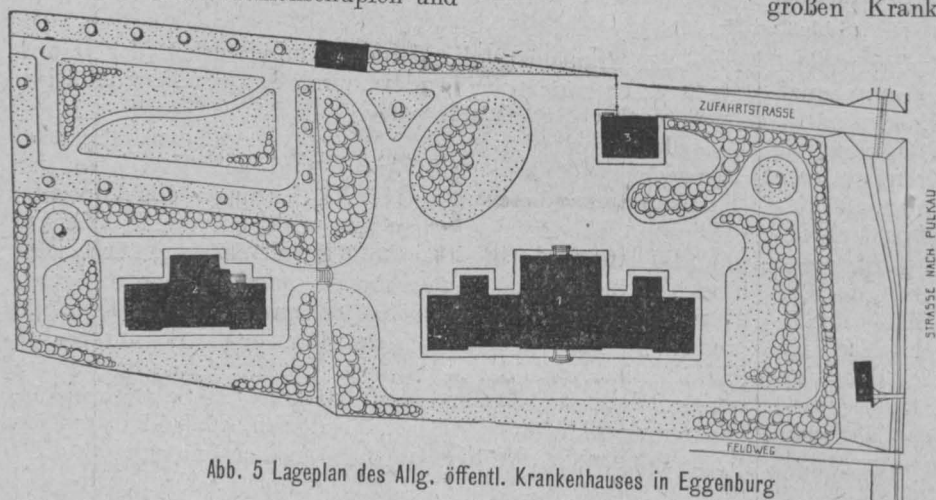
Lageplan des Allg. öffentl. Krankenhauses in Eggenburg
